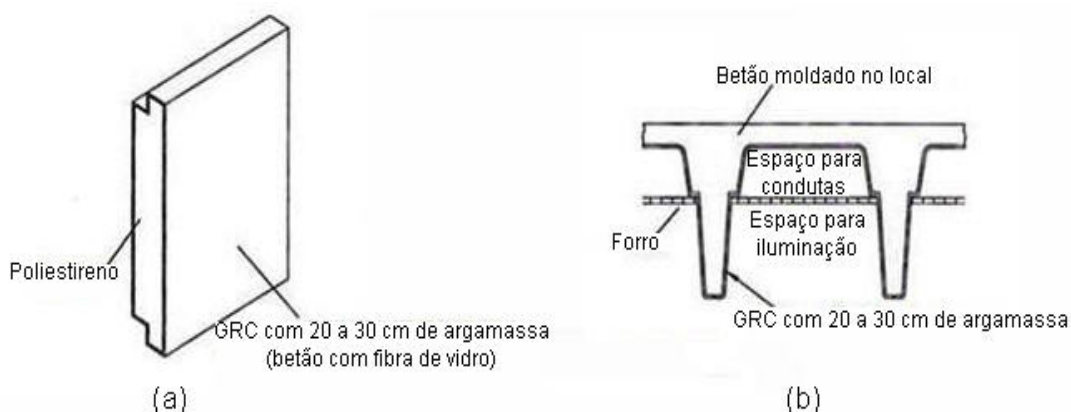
Exemplos de aplicação de betão armado com fibras a) Painel pré-fabricado com poliestireno com GRC projectado; b) Painel pré-fabricado de GRC como cofragem perdida (adaptada de [2])
